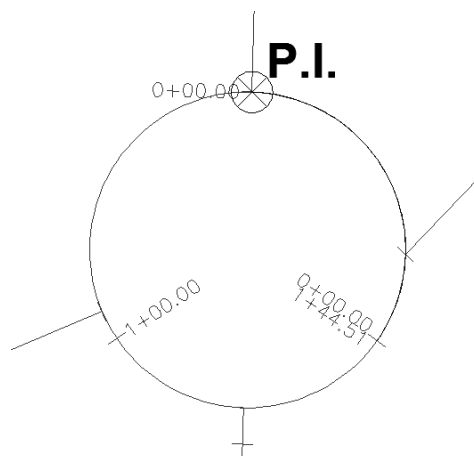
Intersecção em Planta entre o eixo do Restabelecimento 2 e a Rotunda A
